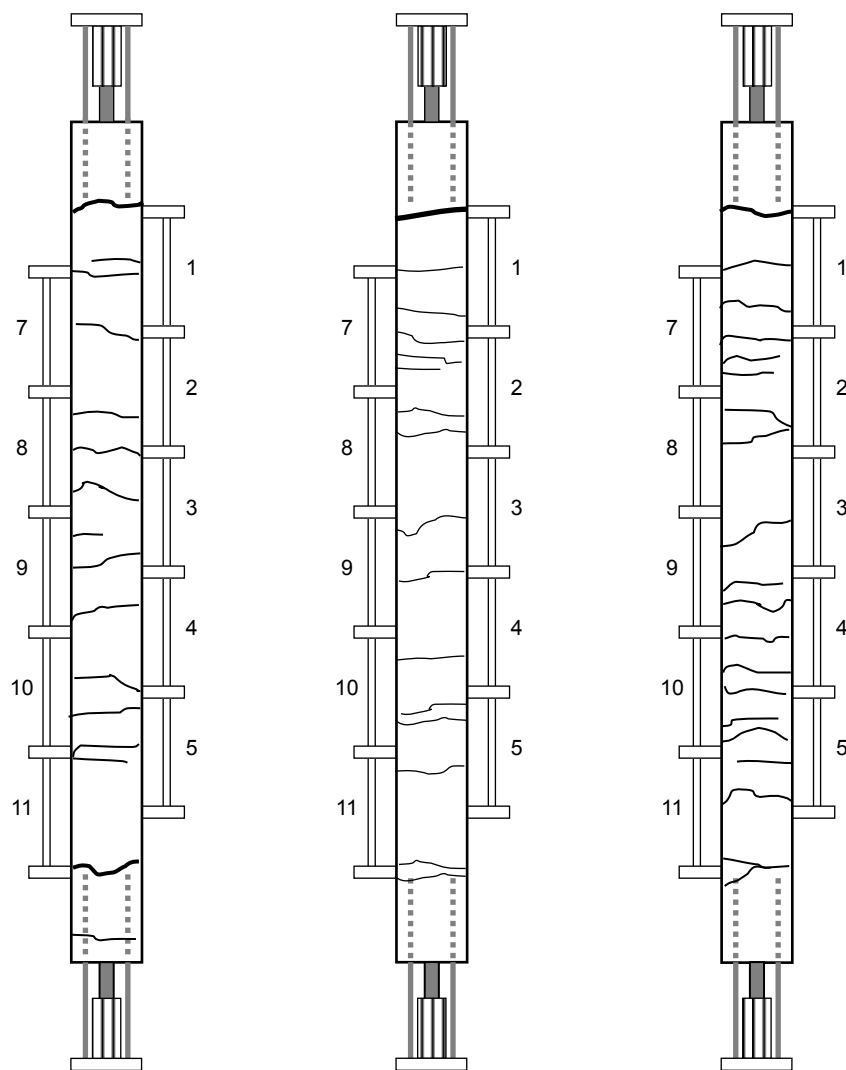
両引き試験体のひび割れ図 (TS16-x(c))
